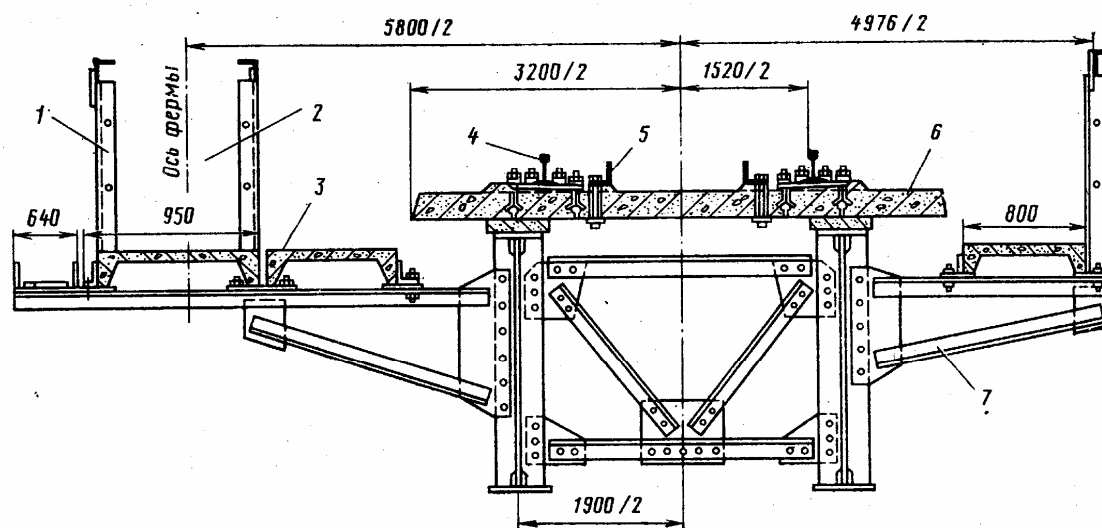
Мостовое полотно с безбалластной железобетонной плитой
